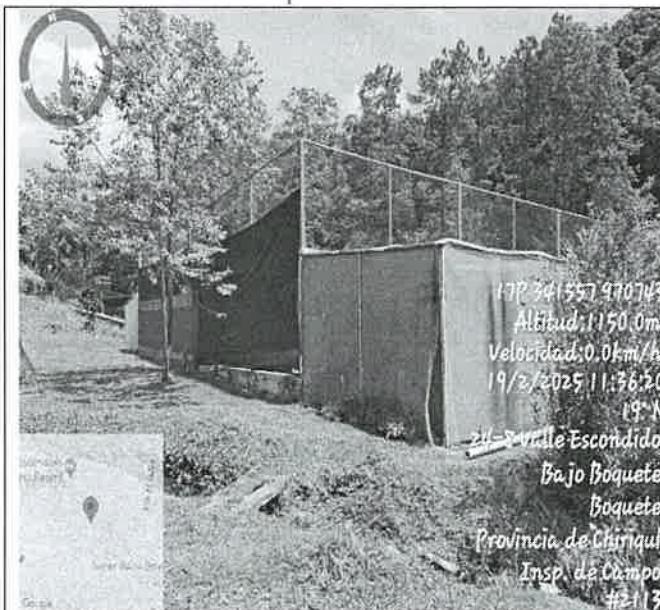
Vista de la cancha de tenis, el cual será removido.
